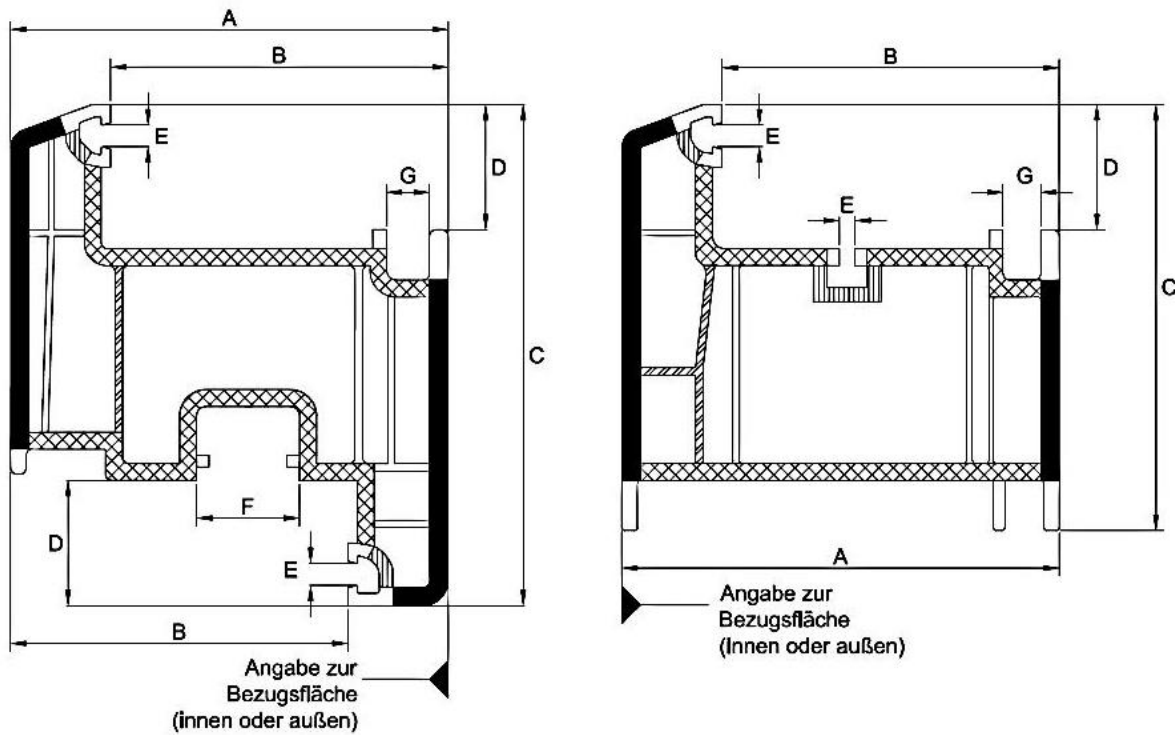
Beispiele für Querschnittszeichnungen Flügel- und Rahmenprofil
